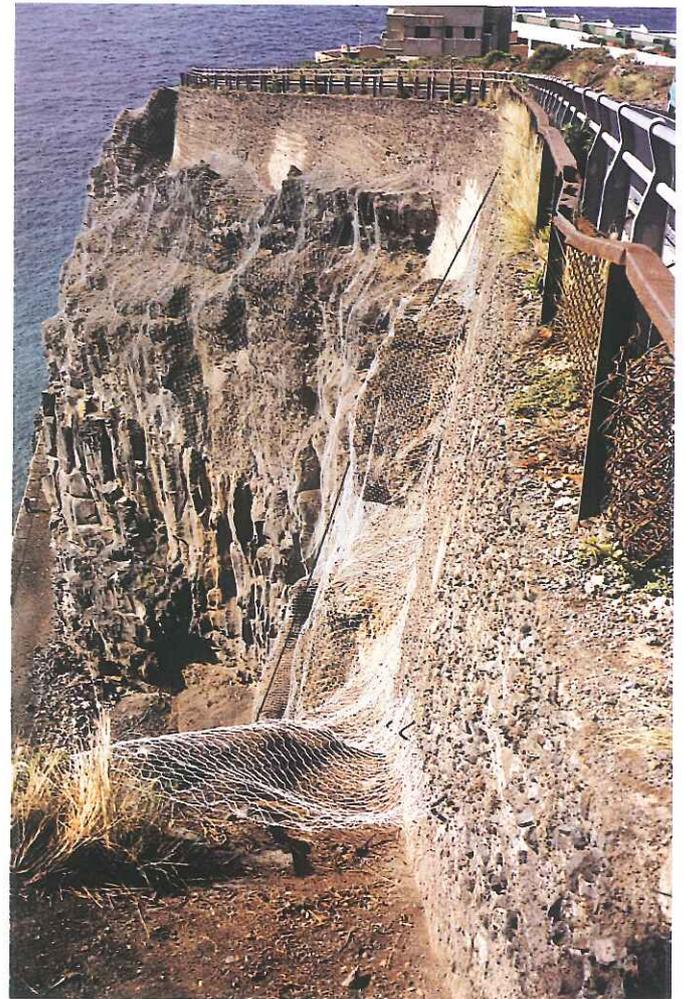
Mallas en fase de colocación. Más abajo la zona de bulonado. A la izquierda (abajo) uno de los accesos.
